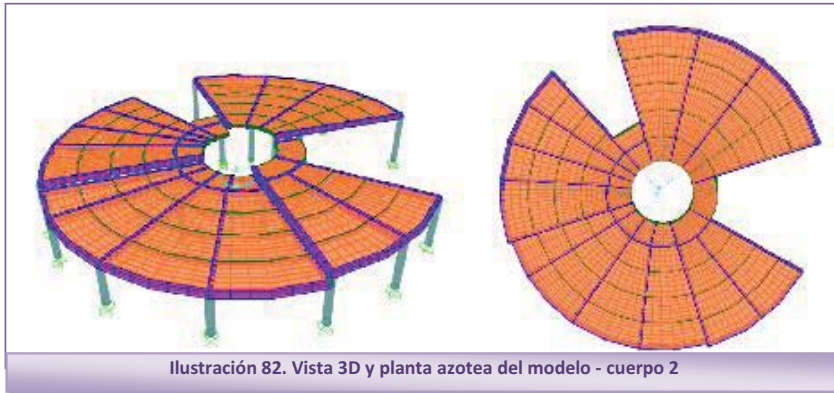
Vista 3D y planta azotea del modelo - cuerpo 2
